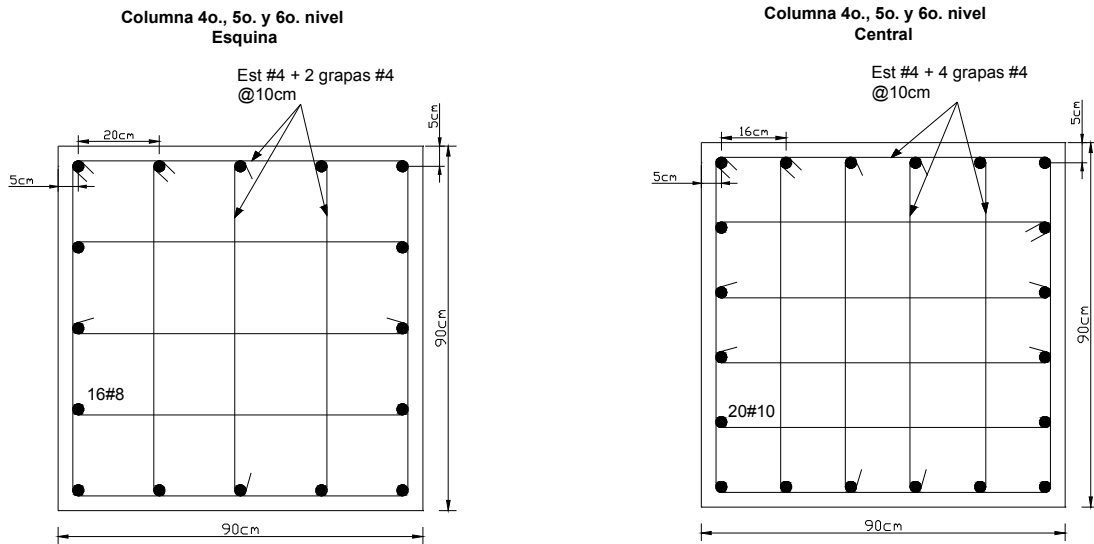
Detallado de estribos en los extremos de las columnas, niveles 4, 5 y 6
